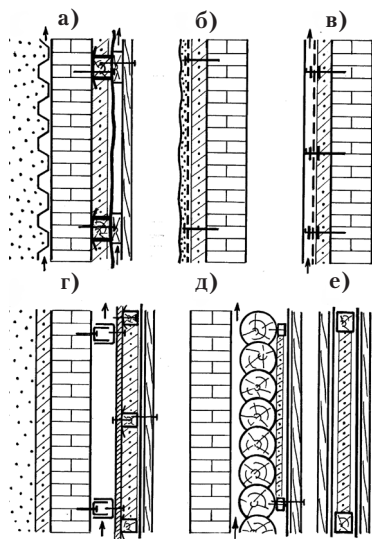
Примеры монтажа многослойных стен. Слева – наружная сторона стены, справа – внутренняя сторона стены, направленная в помещение. Перечисления слоёв слева направо: а – грунт, вентилируемая гидроизоляция типа «фундалин», вентилируемый зазор (продух), кирпичная (бетонная) стена подвала, прокладки рубероида, деревянные бруски с заложённым между ними враспор утеплителем (плитой из пенопласта или минваты), листовая (рулонная) пароизоляция, деревянные планки для уплотнения нахлёстов пароизоляции, деревянная обшивка; б – тонкий 8–12 мм паропроницаемый штукатурный слой, жёсткая плита из минваты, прижатая металлической сеткой, стальные оцинкованные кронштейны (стержни, шпильки, крепежные элементы) для фиксации утеплителя, кирпичная (бетонная) несущая стена; в – защитно-декоративный экран (металлический, пластиковый, стеклянный, асбоцементный), вентилируемый зазор, металлическая
